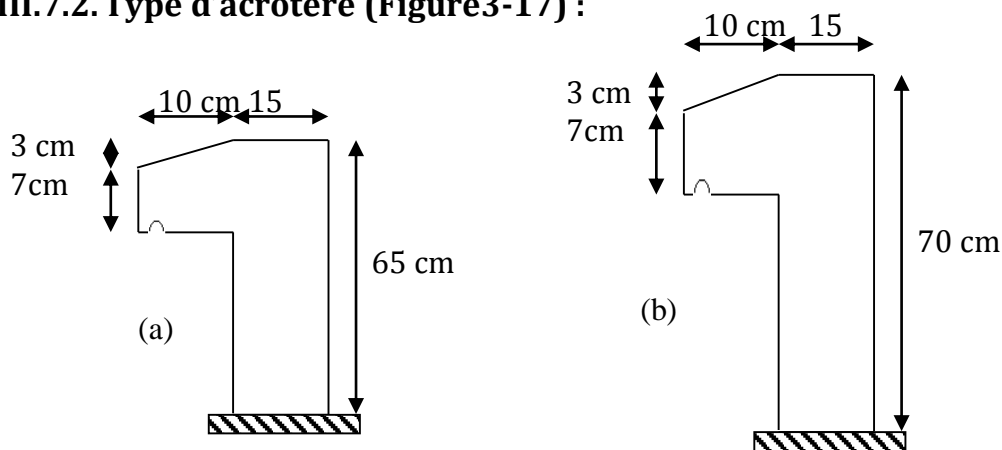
21 : Vue en plan des acrotères pour terrasse inaccessible (a) et terrasse accessible (b)
